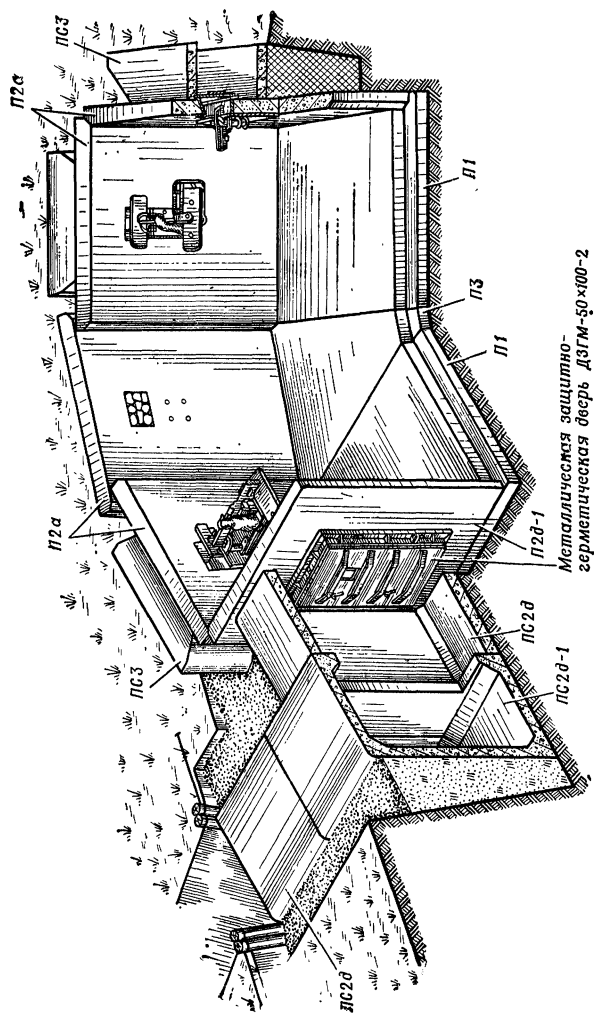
Сборное железобетонное пулеметное сооружение СПС-2М (план, разрез)
